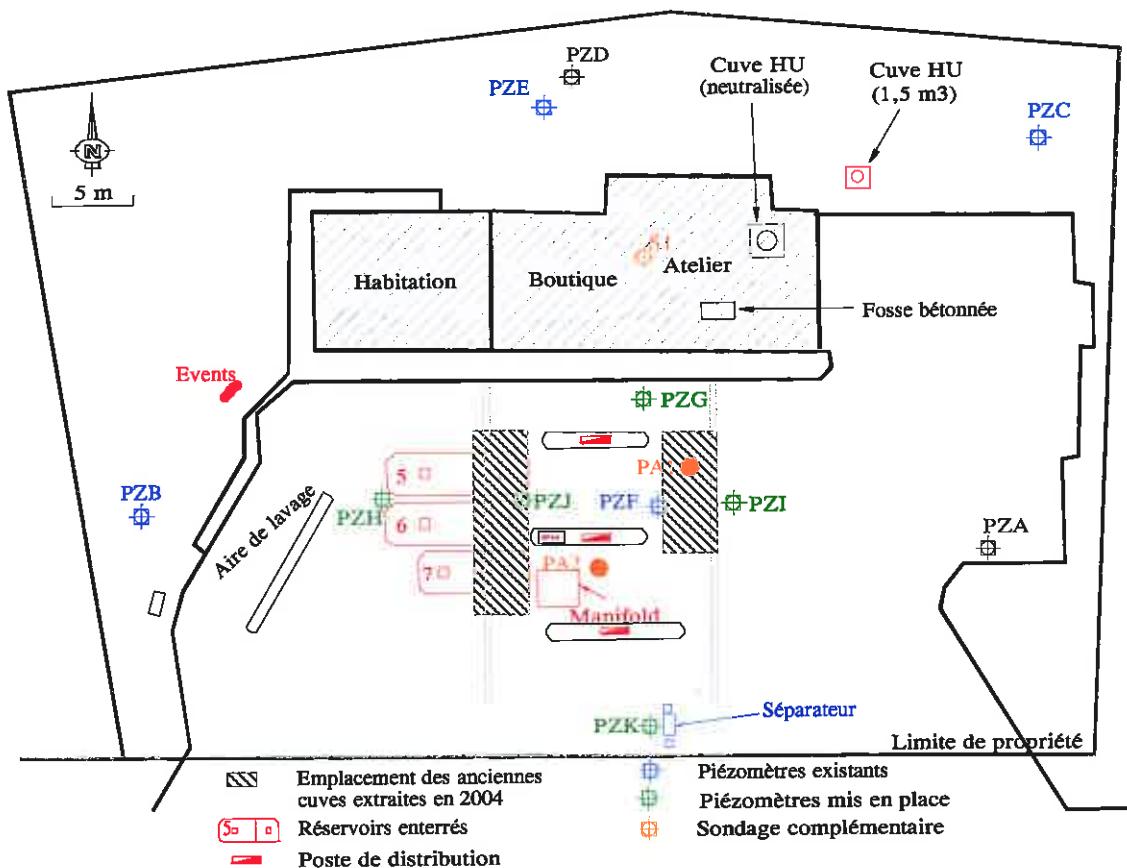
Plan d'implantation des nouveaux ouvrages AMDE (04.089.A.AF(R.09.1).07.1)
